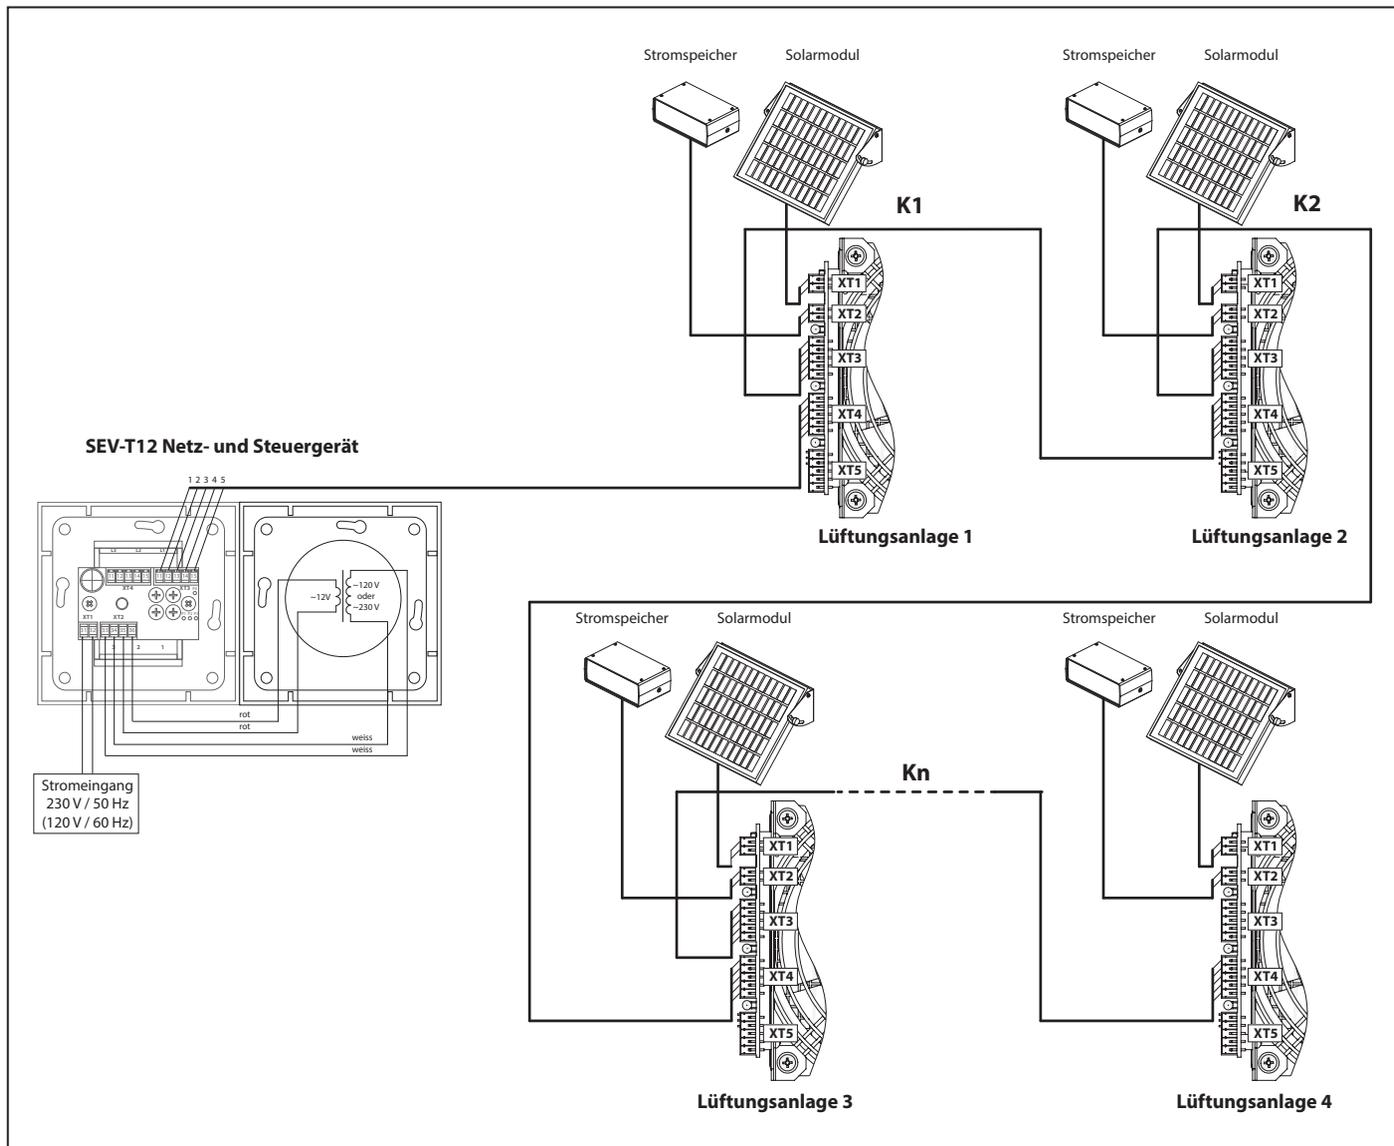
Anschlusschema zur Verbindung mehrerer Lüftungsanlagen VENTO Solar V60 Pro2
